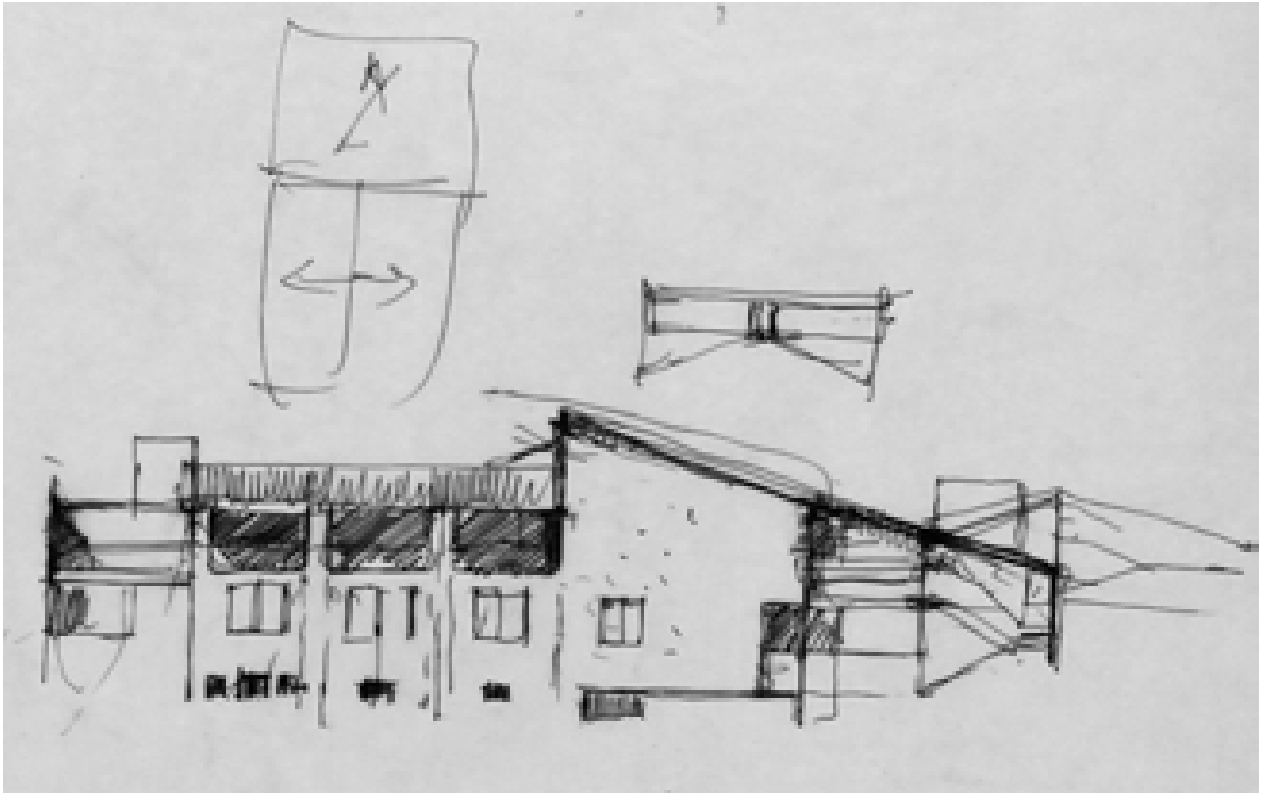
Prospetto, stato futuro – 30/08/1989 (AABS-64_434)
